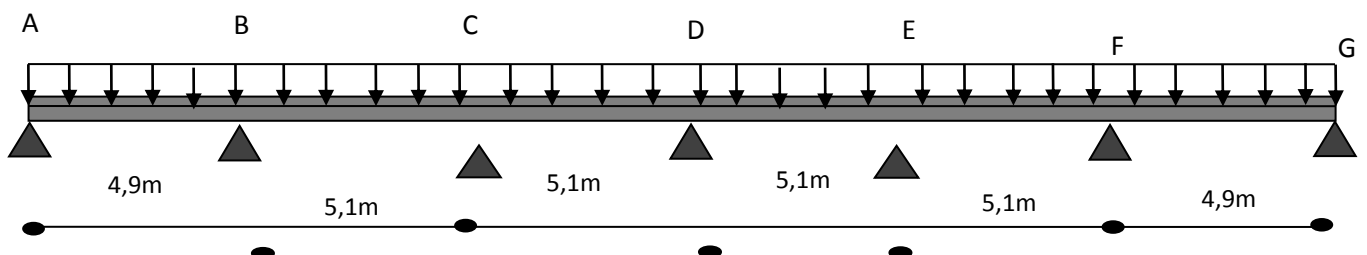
Schéma statique de la poutrelle à 2 et à 6 travées
